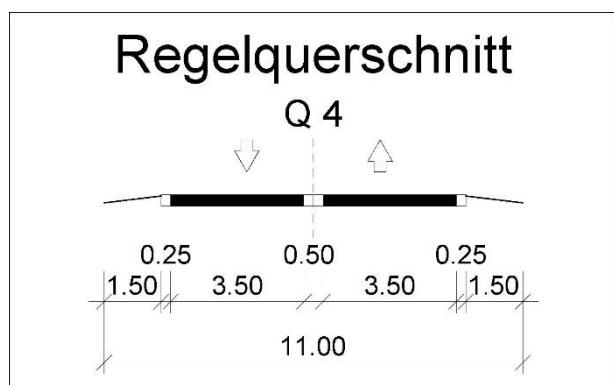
Querschnitt Q 4 Rampenfahrbahn B=8,00 m, Systemskizze
